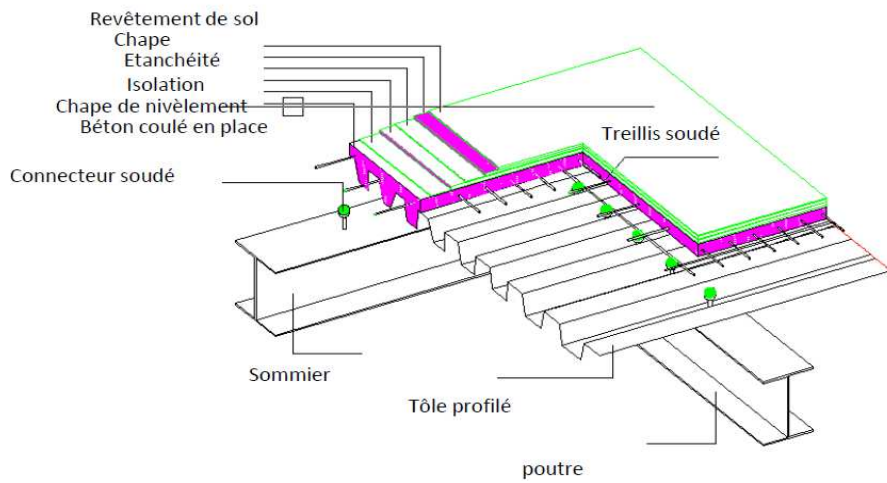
plancher collaborant ; source: <http://www.batirama.com>.
